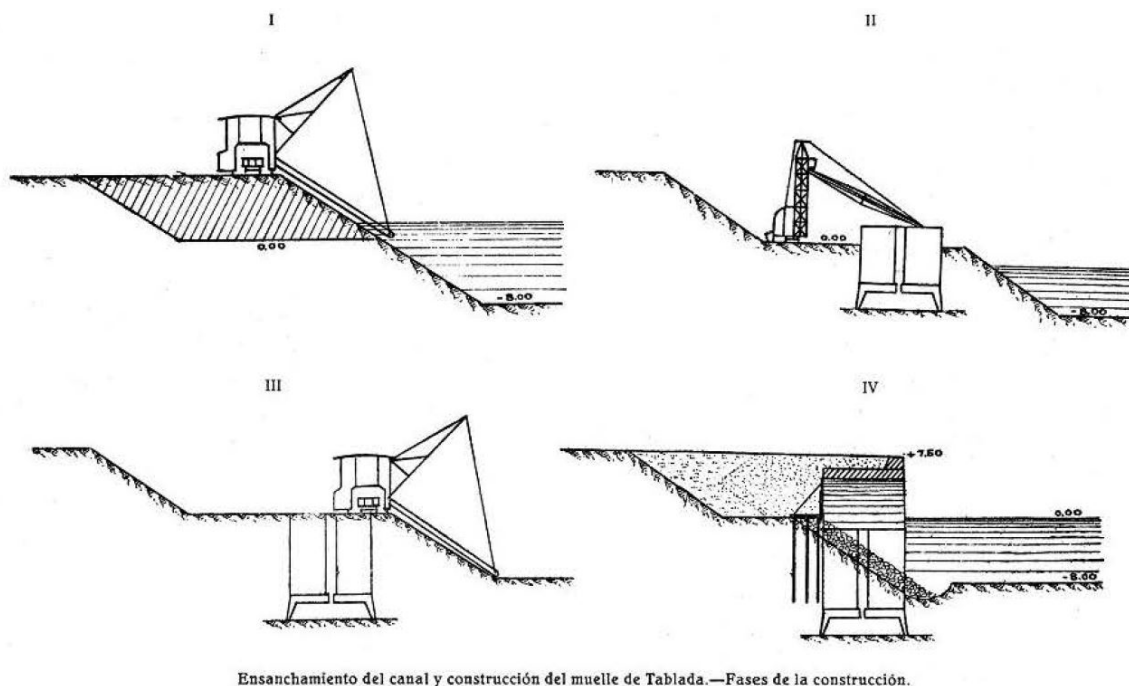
Ensanchamiento del canal y construcción el muelle de Tablada – Fases de la construcción, *Revista de Obras Públicas*, nº 2.459, agosto 1926, p. 374.
